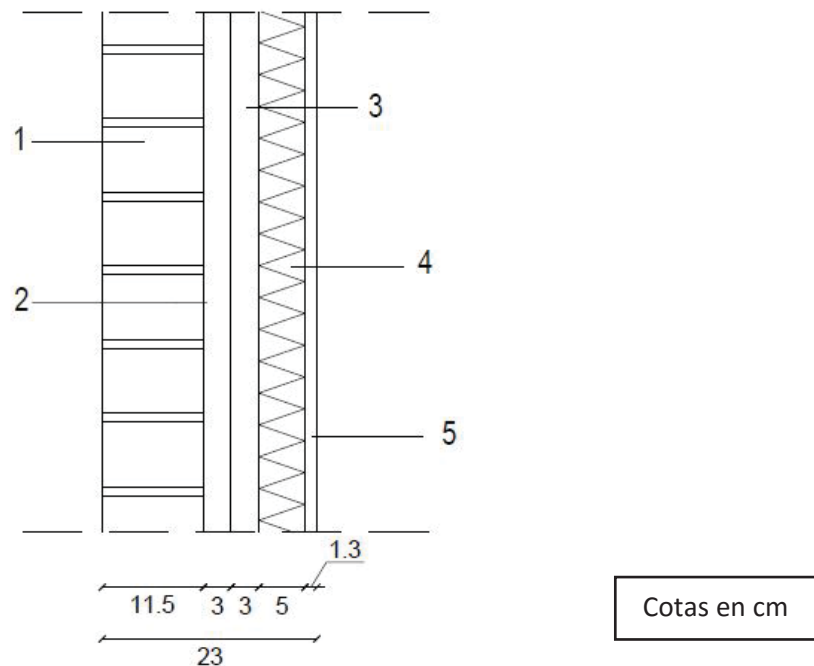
Detalle cerramiento 1. Fuente: Elaboración propia.
